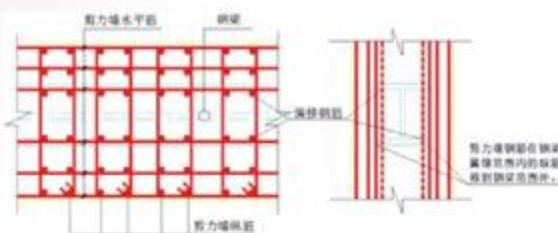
核心筒剪力墙纵筋遇钢梁钢筋做法示意图
